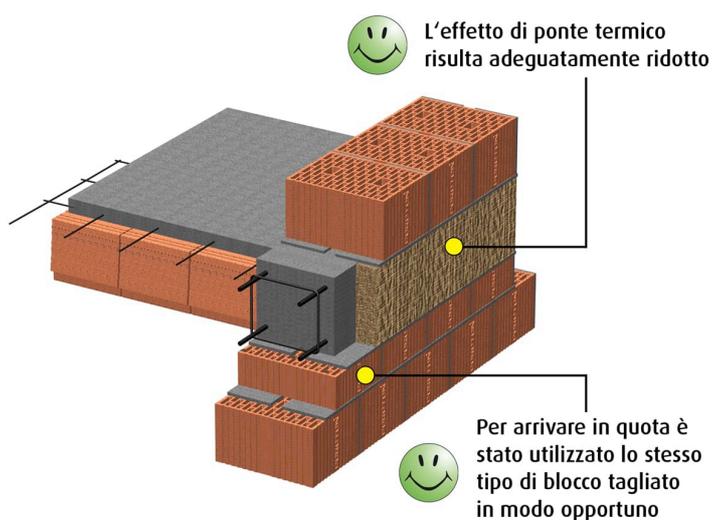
Particolare del nodo muratura-solaio: soluzione corretta con riduzione del ponte termico.
